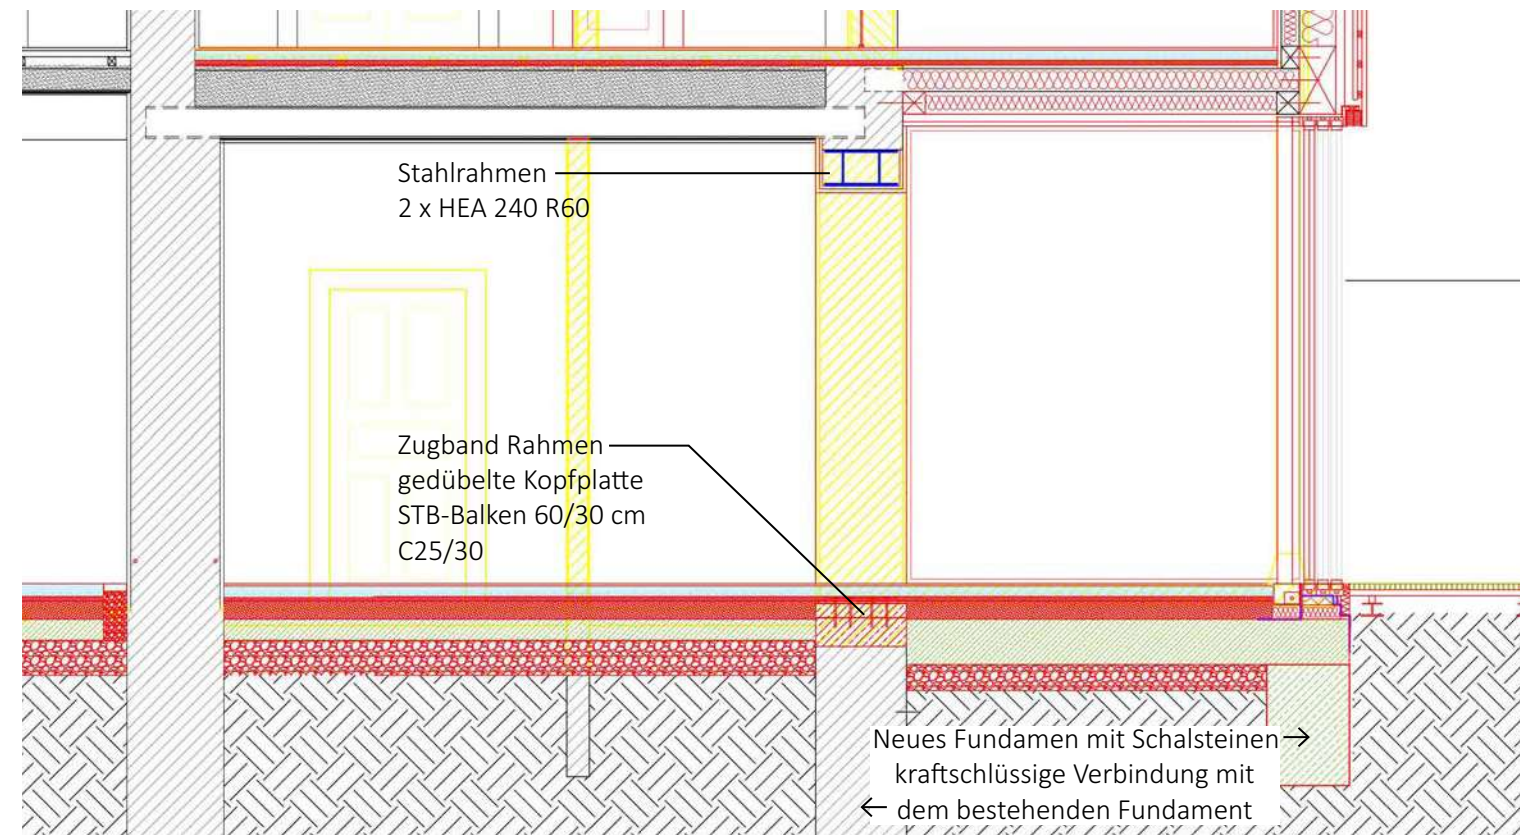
Detailschnitt mit dem Durchbruch durch die tragende Außenwand und den statischen Angaben zur Herstellung eines Rahmens, M=1:50.
